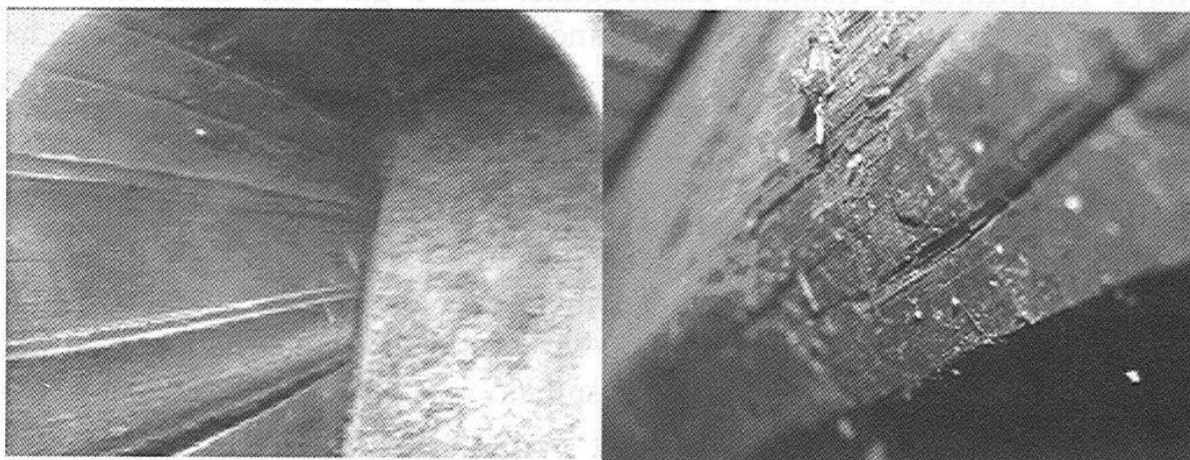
Rilievi endoscopici delle strutture in legno nell'intercapedine sotto la pavimentazione
